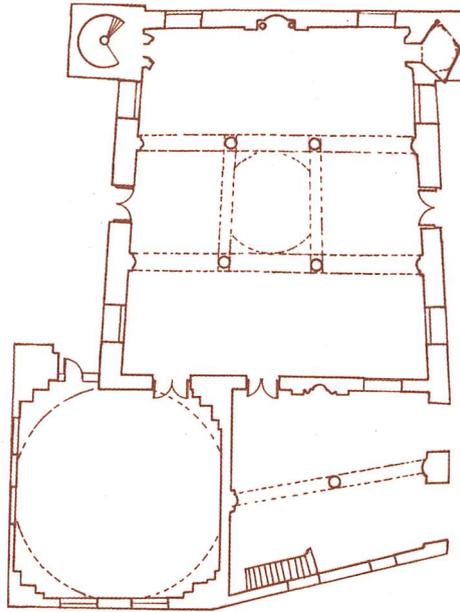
المسقط الأفقى لقاعدة مئذنة مسجد الوكيل بسمخراط
